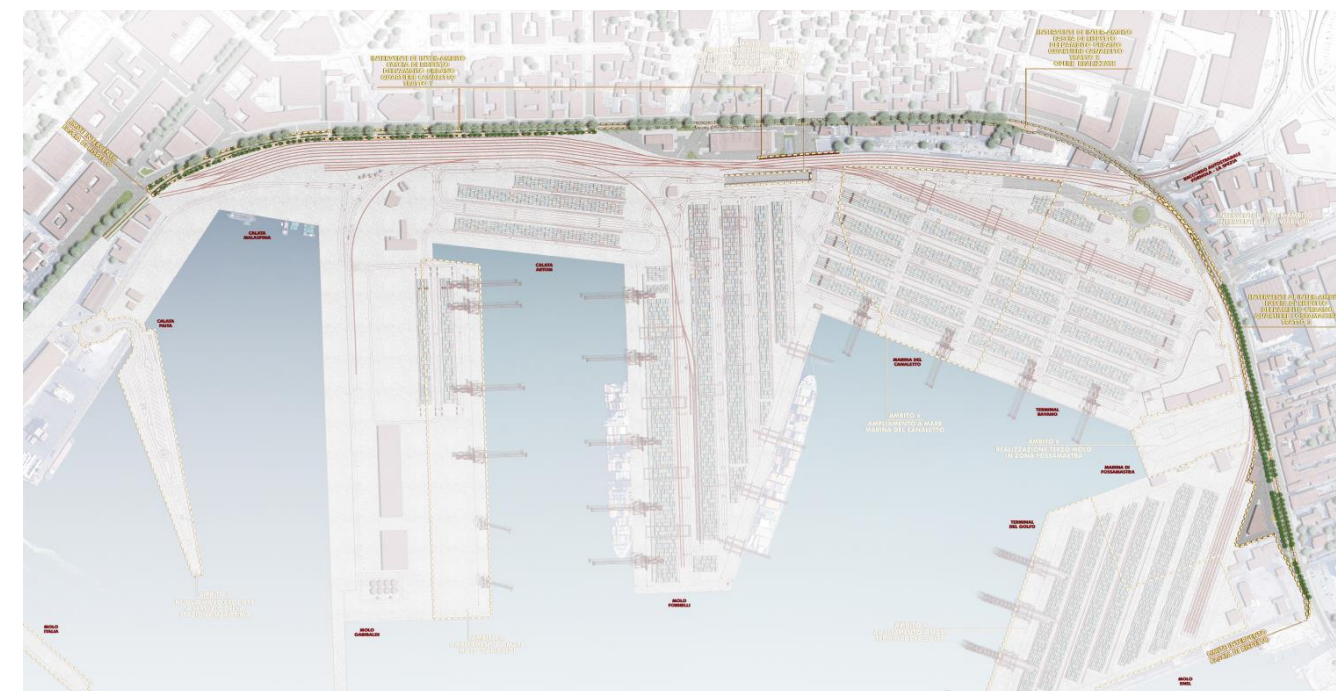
Fascia di rispetto per gli ambiti urbani quartiere Canaletto e quartiere Fossamastra a seguito della rimozione del primo e secondo binario ottenuta grazie al progetto di potenziamento degli impianti ferroviari - Planimetria generale dell'intervento
